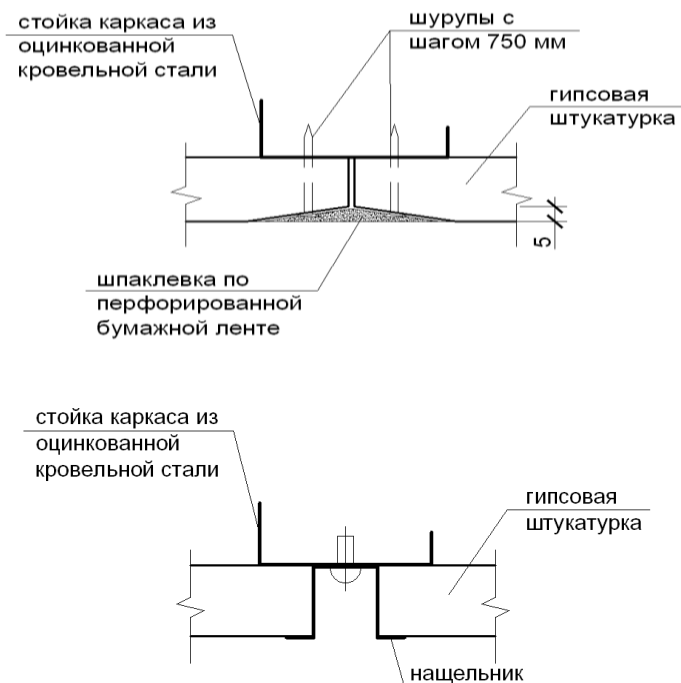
Крепление обшивок перегородки к стойкам каркаса и разделка стыков
